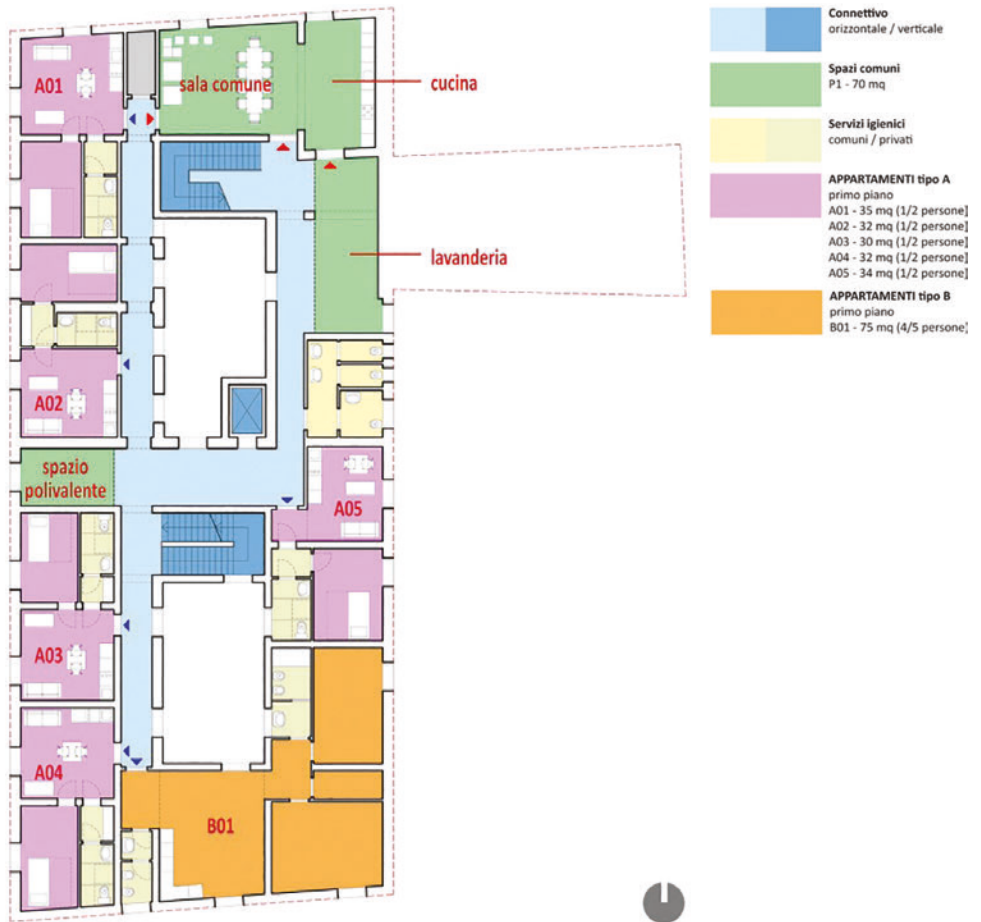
Il Condominio Solidale: Pianta Primo Piano.
